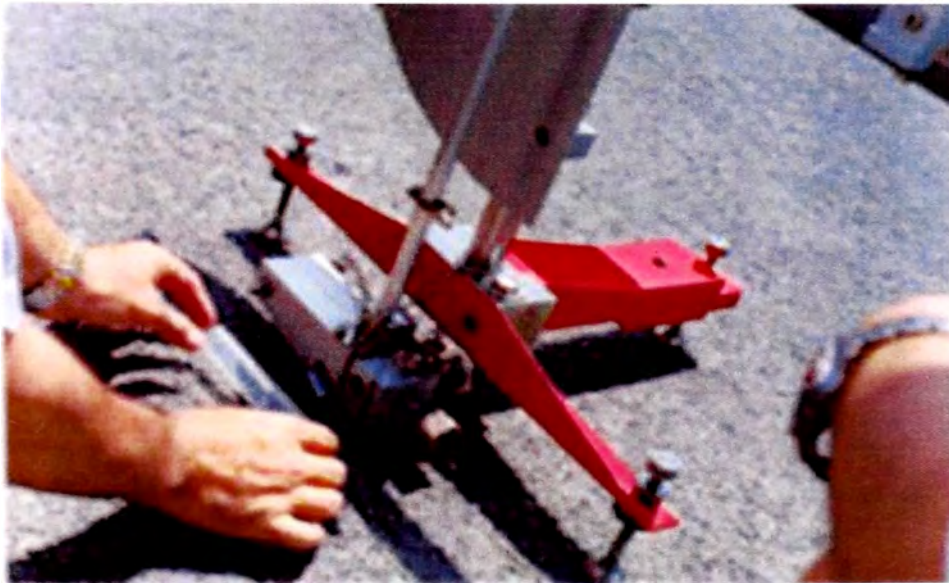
Escantillón para definir la distancia normada a deslizar la zapata del péndulo.
